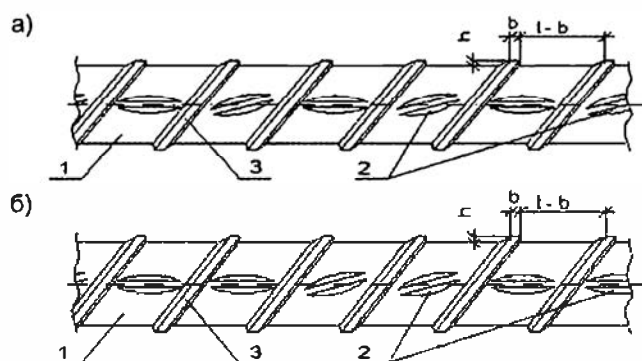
Пример непрерывной маркировки класса арматуры для изготовления железобетонных конструкций
